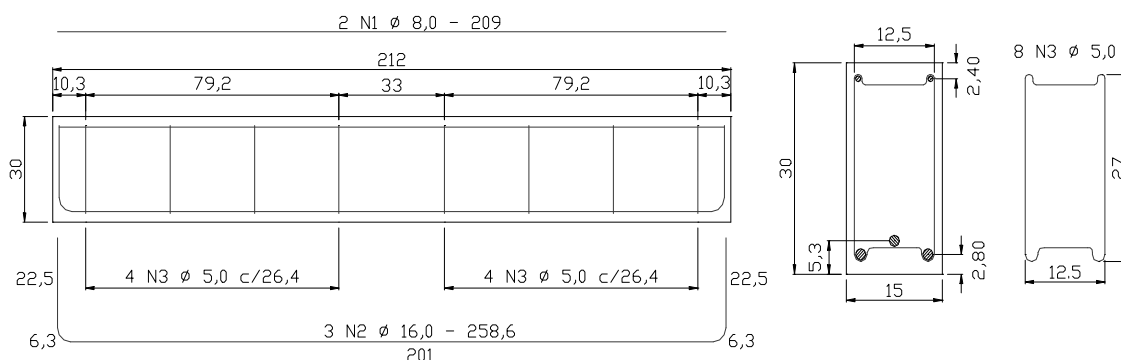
Detalhamento das armaduras das vigas (cotas em cm)
